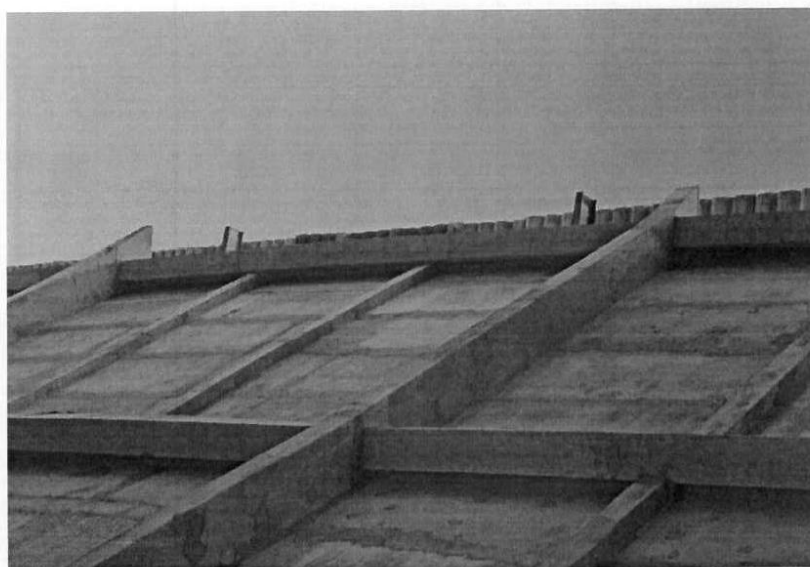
Estrutura metálica com sobra a fachada do prédio
